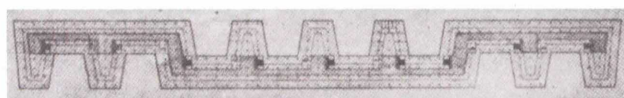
1930年「アルジェ計画オビュ A」超高層建築の平面図
